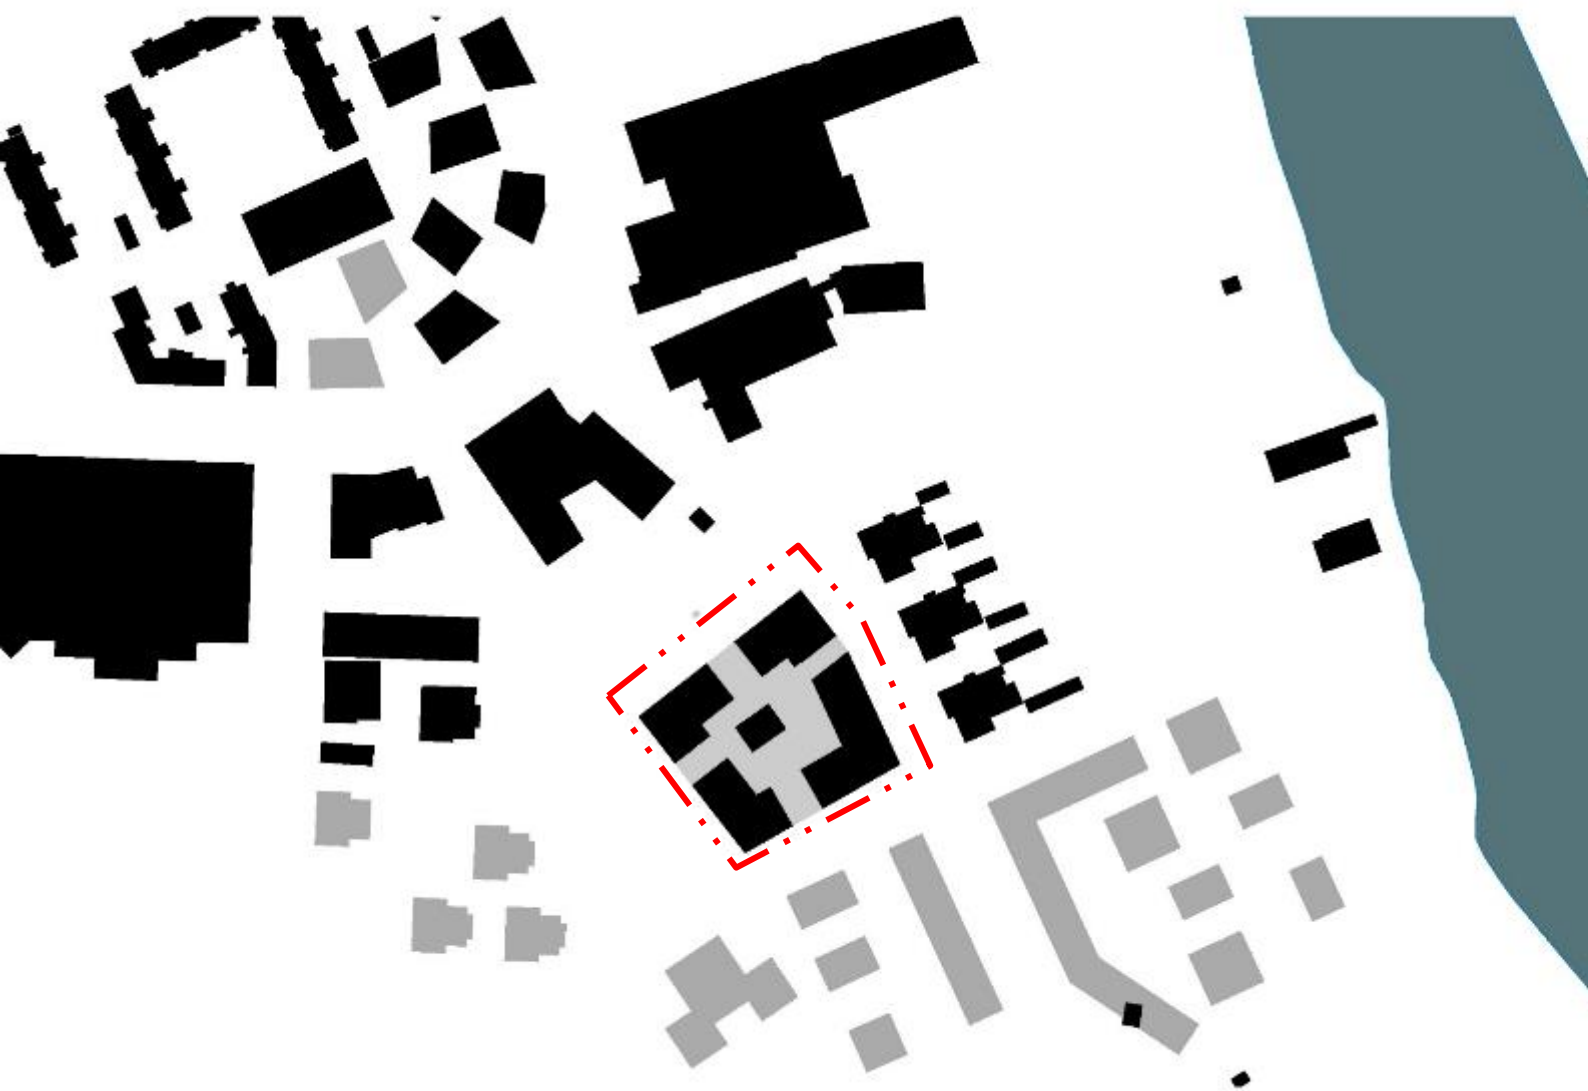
Anpassning till miljön, kvarterets placering i stadsstrukturen.
